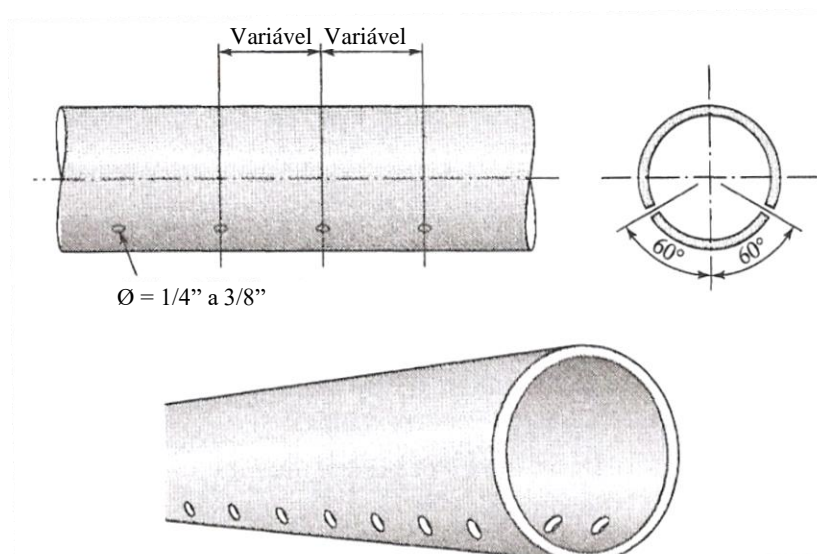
Tubo perfurado utilizado em trincheiras de coleta de percolado. Modificado de Qian, Koerner e Gray (2002)
